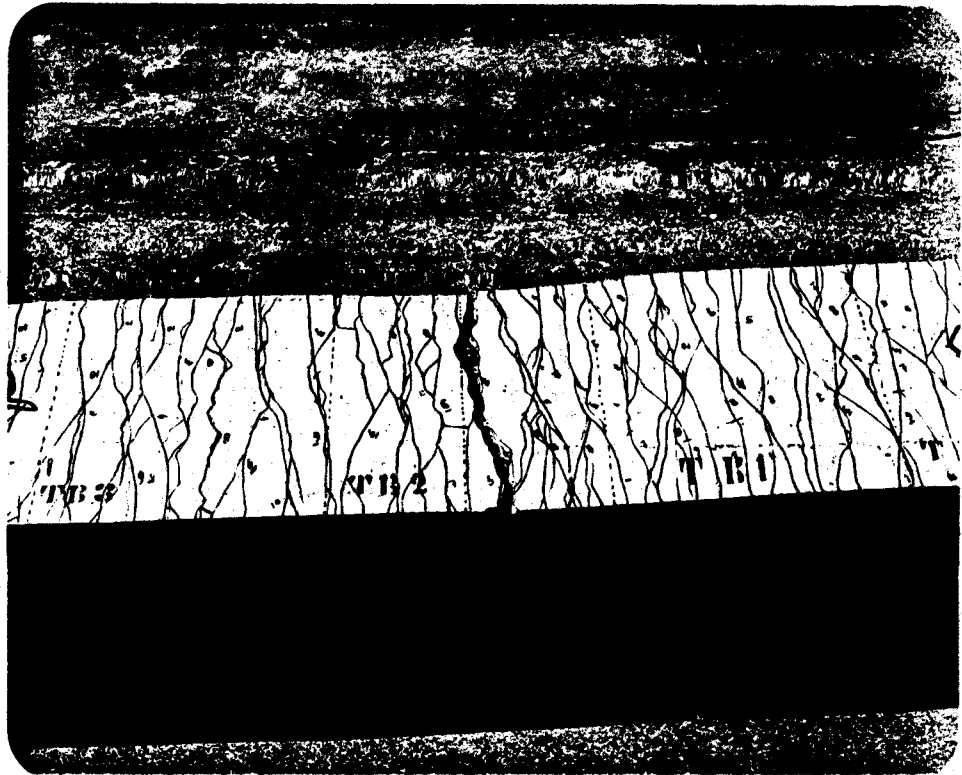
Configuração de fissuras final do modelo FIII18T
